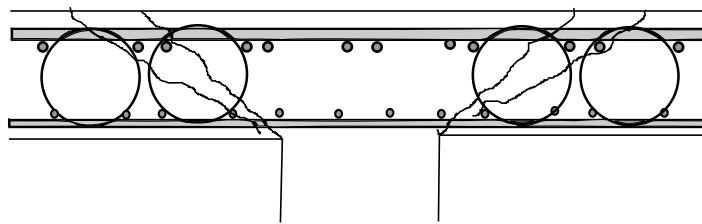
Padrão de fissuração, seção transversal Held (2002)
